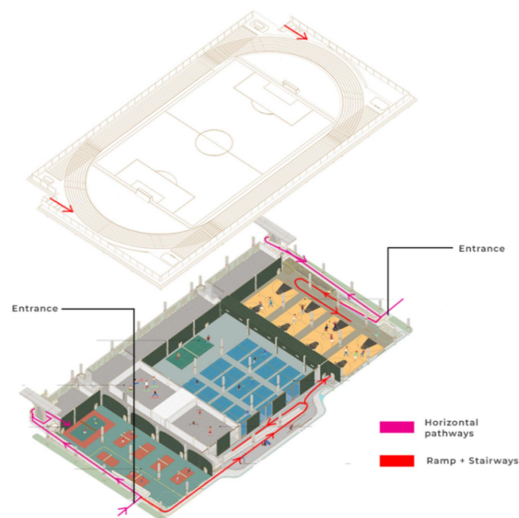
Denah Sport Field of Shaoxing University Lantai 2
